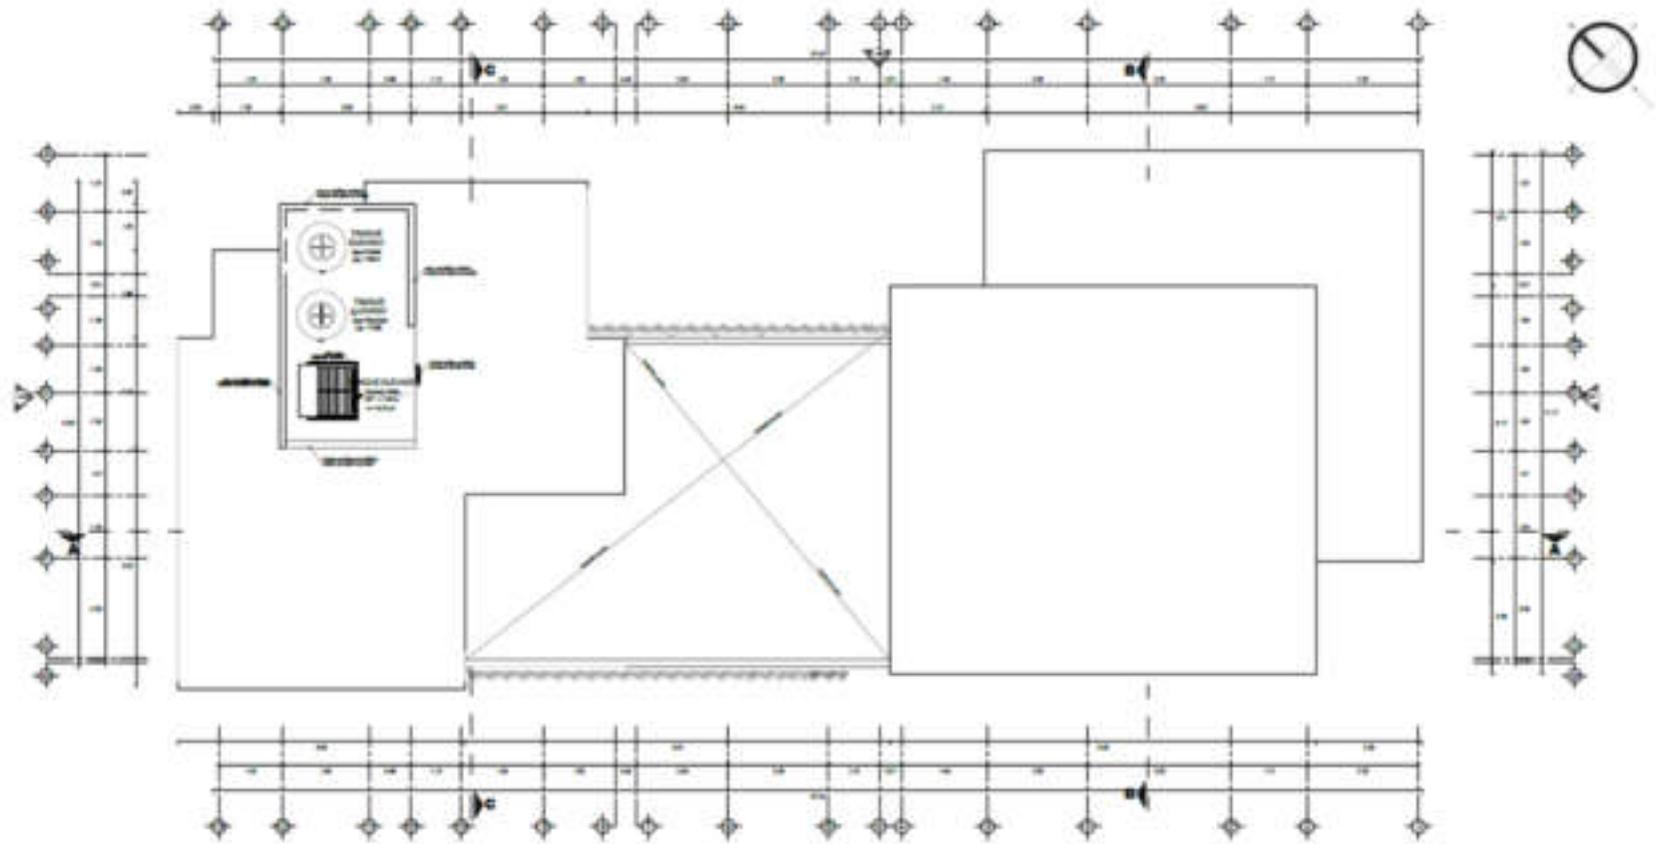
Planta de distribución, Nivel de tanque-Vivienda tipo II
